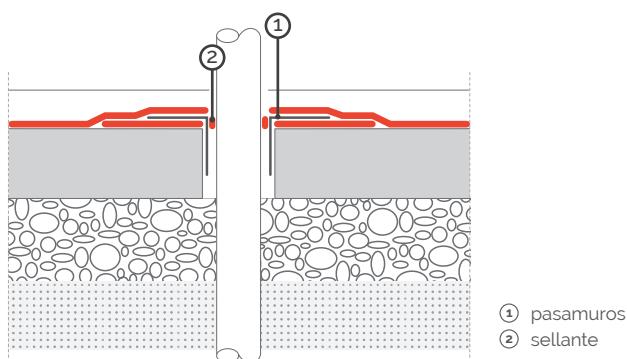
Encuentro de la barrera tipo lámina con un elemento pasante vertical mediante un pasamuros
